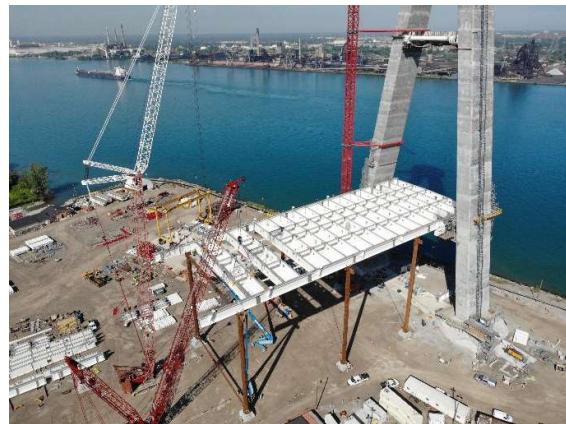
Vista del montaje metálico del vano de retenida sobre apeos provisionales.
